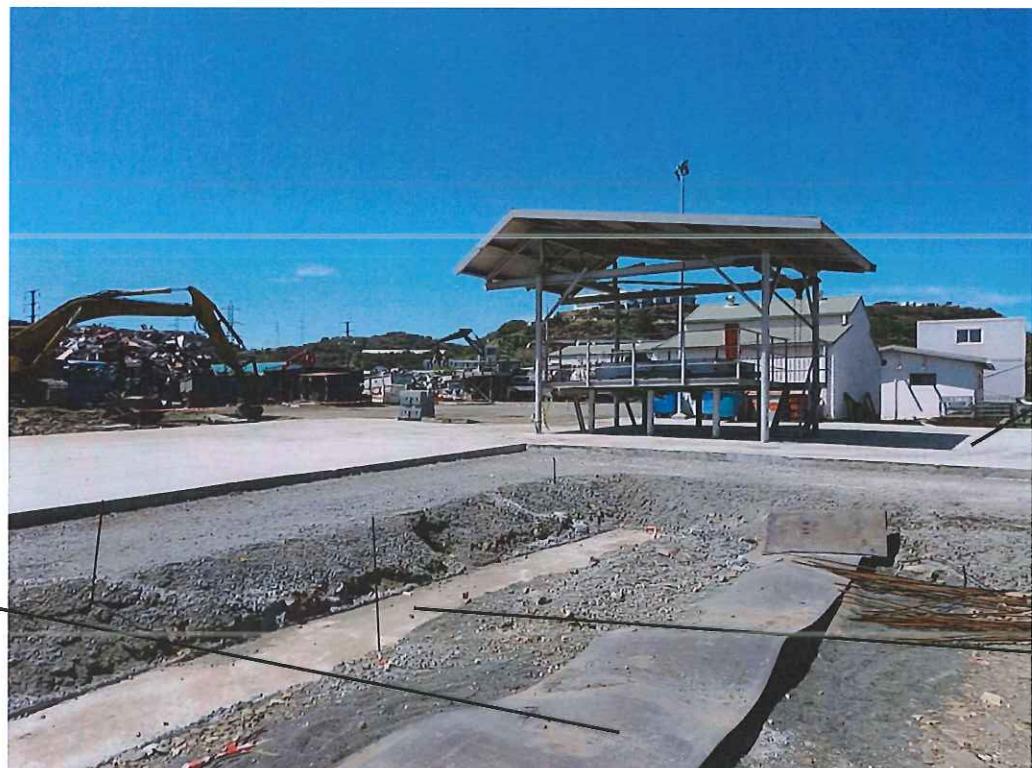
couverture horizontale des zones de la tranche 1B et de la tranche 3 (vue en direction de l'Ouest)
